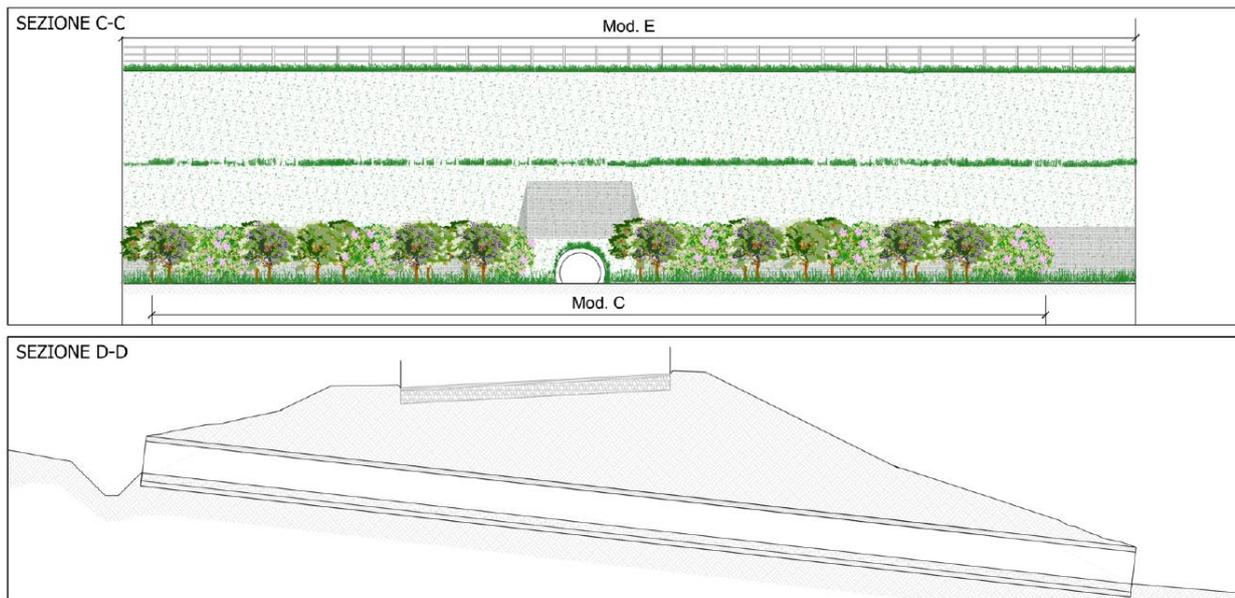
Barriera antiattraversamento di esercizio (particolare passaggio faunistico)
